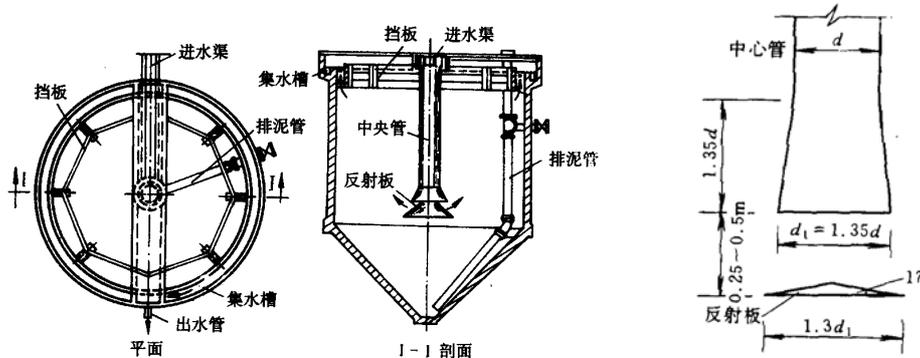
Grundriss eines vertikal durchströmten Rundbeckens (Quelle: [L-14])
